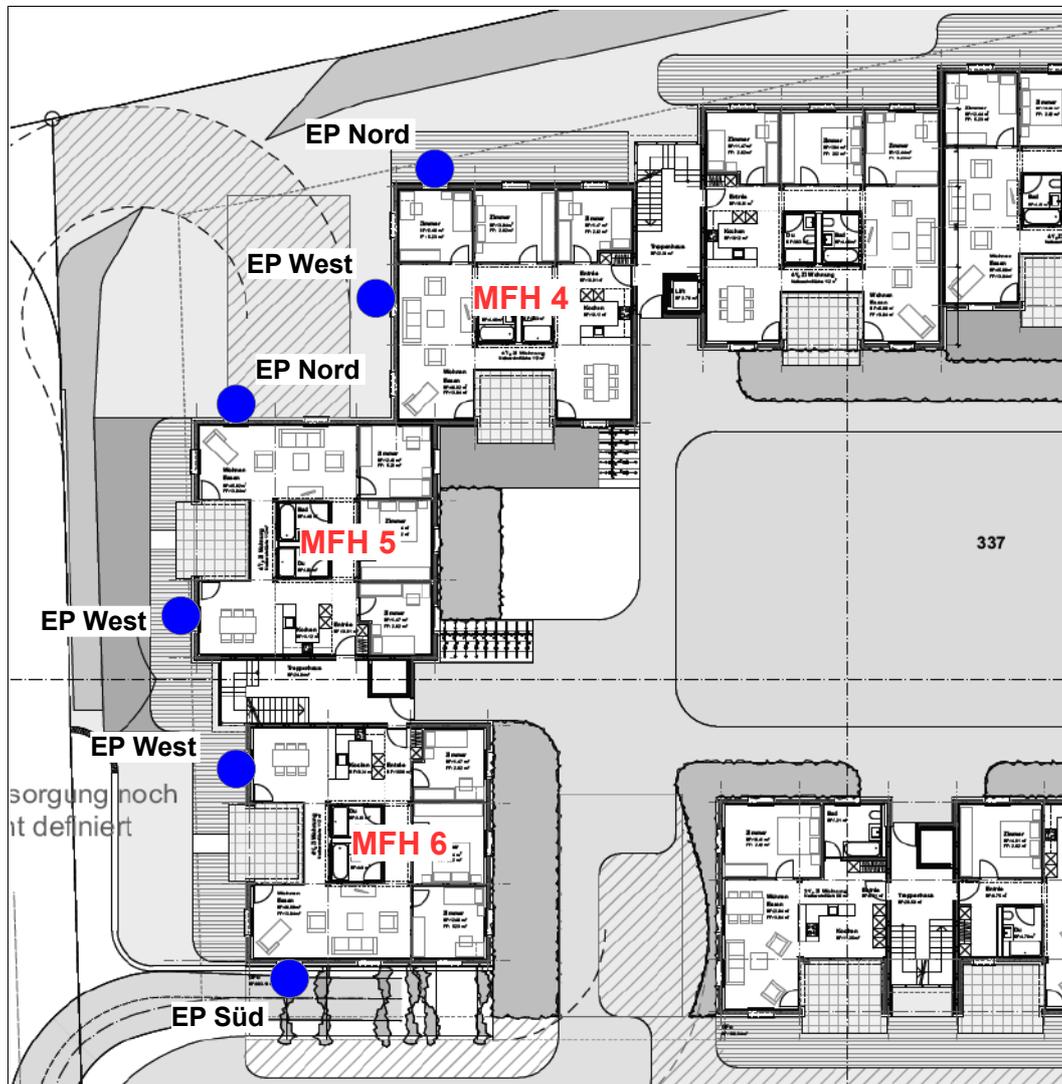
Ausschnitt Grundriss EG, ohne Mst.; Quelle: Architekt
